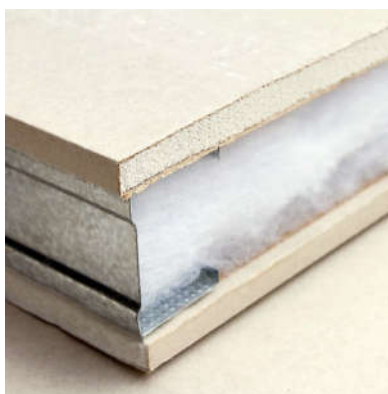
Lã de pet em sistema drywall com placas de gesso acartonado.
